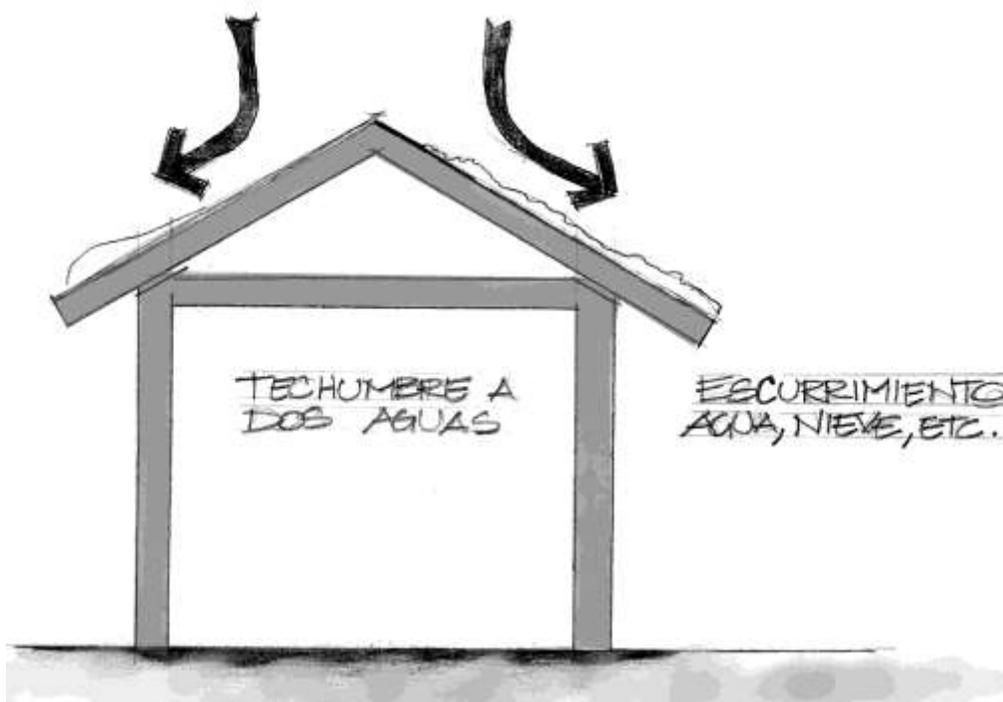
ejemplos de construcción particular, legado de sistemas constructivos Fuente: El Autor
